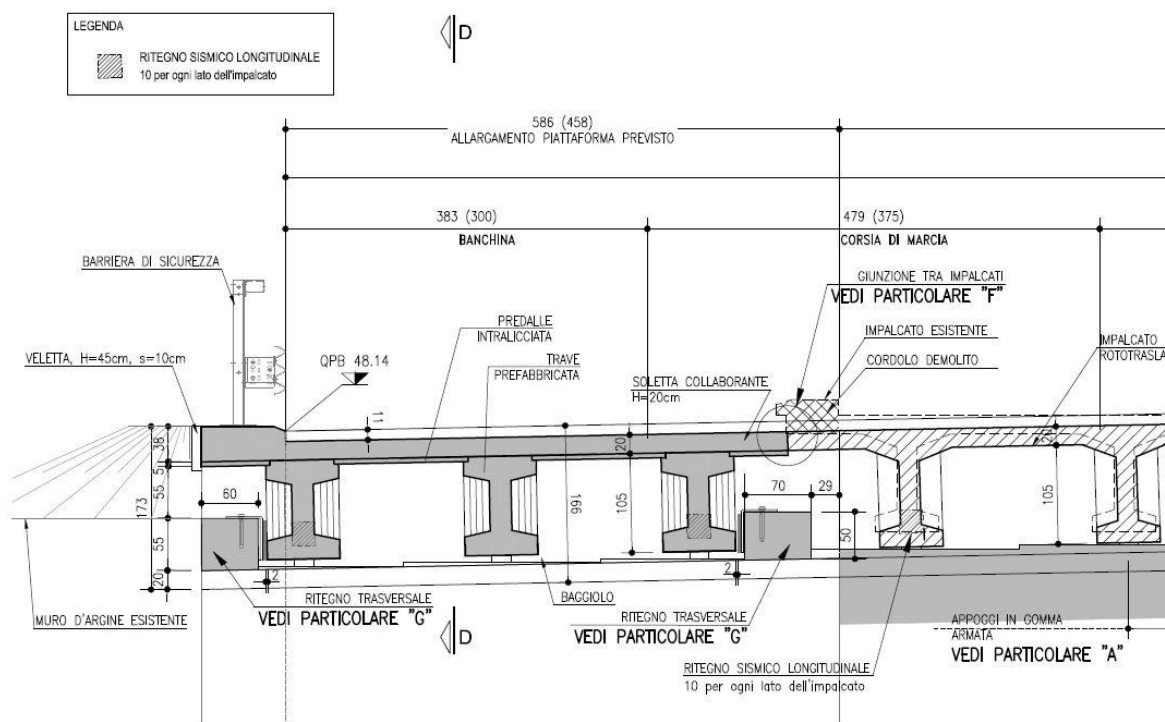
Sezione tipo struttura di sostegno in allargamento.
